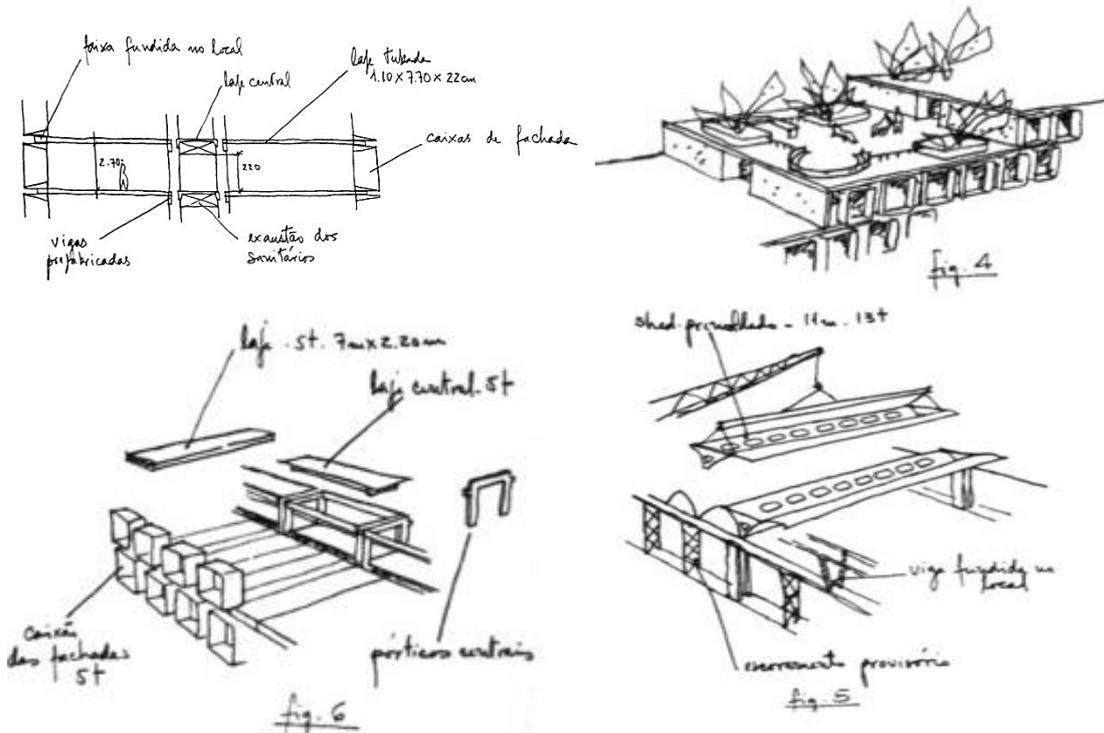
Esquema de piezas y montaje de cajas y vigas sheds prefabricados
